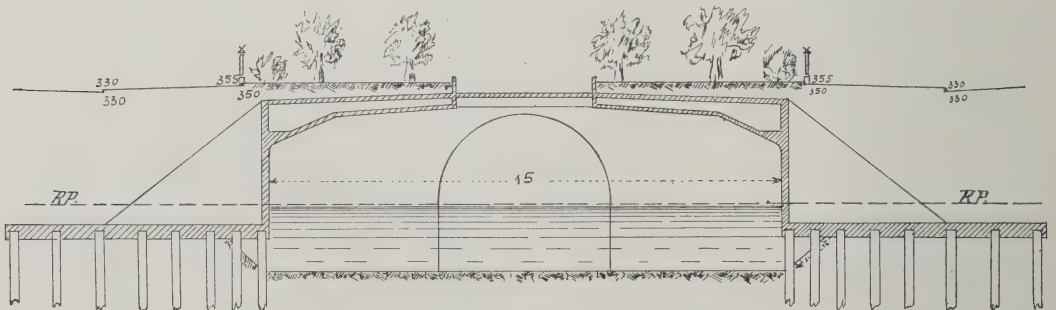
Querschnitt der Widerlager zu Rotterdam.
